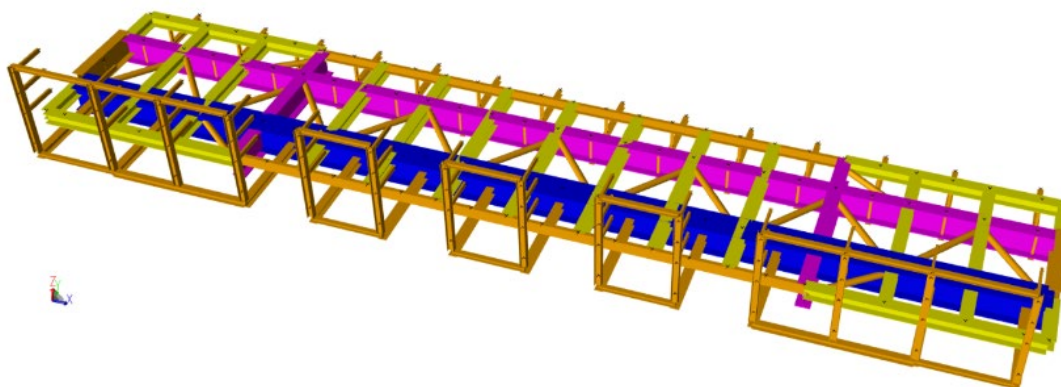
Struttura Passerella Tipo 1 (TG2 e TG3)
